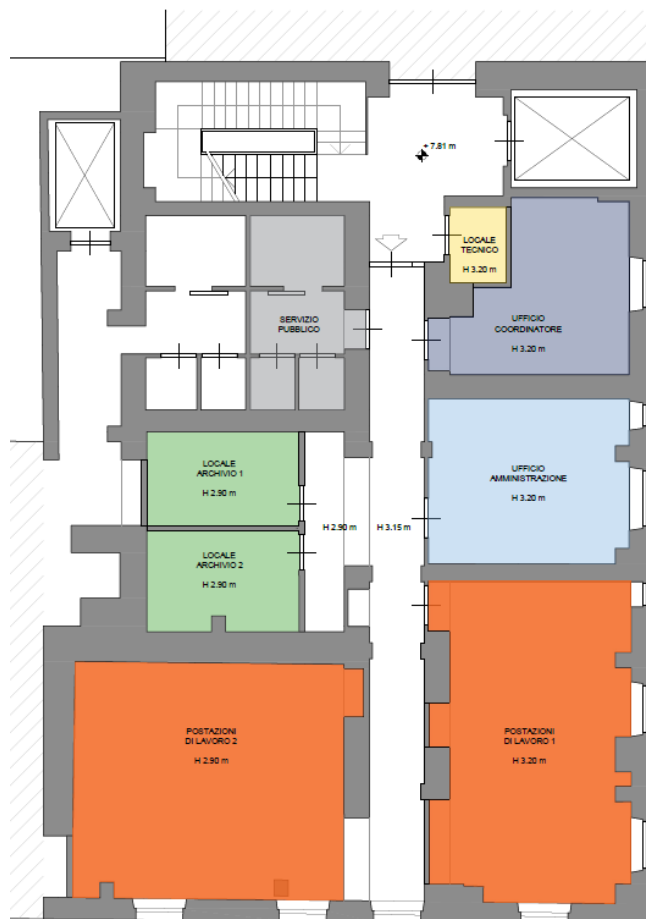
Estratto - Planimetria con indicazione degli usi (COT2\_E\_ARCH\_T\_4002)
